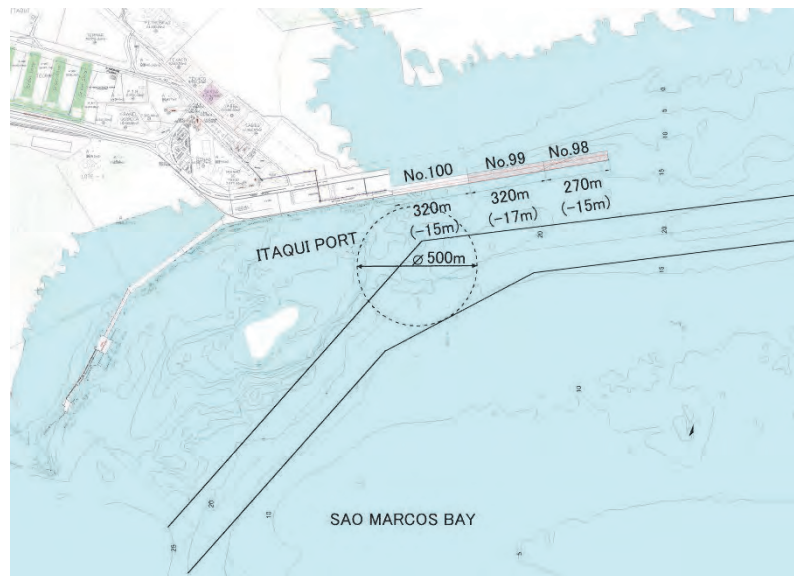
Plano de Distribuição de Instalações do Plano Mestre para o Porto do Itaqui (2030)
